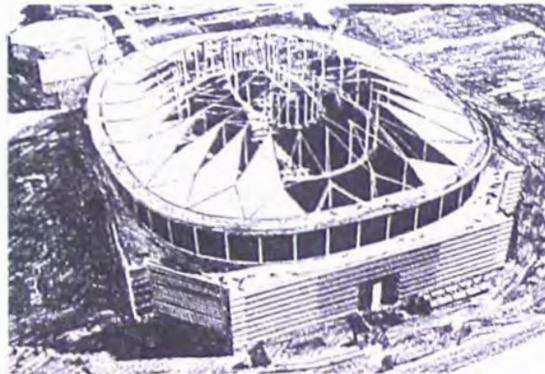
Tomado de: Fuller Moore, Libro: Compresión de las Estructuras en Arquitectura, Georgia Dome en construcción, exterior
